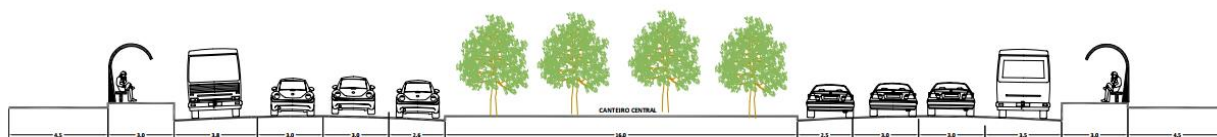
Perfil da Av. Rio Branco após implantação dos terminais e faixas exclusivas
